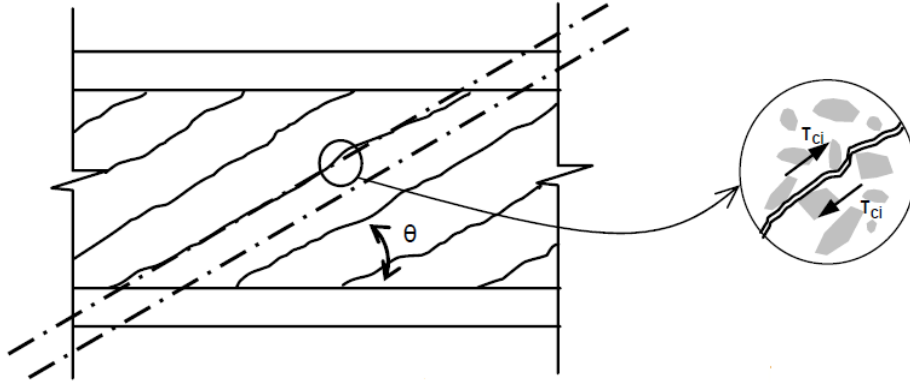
Tensiones locales en la grieta de una viga sometida a cortante [13].
